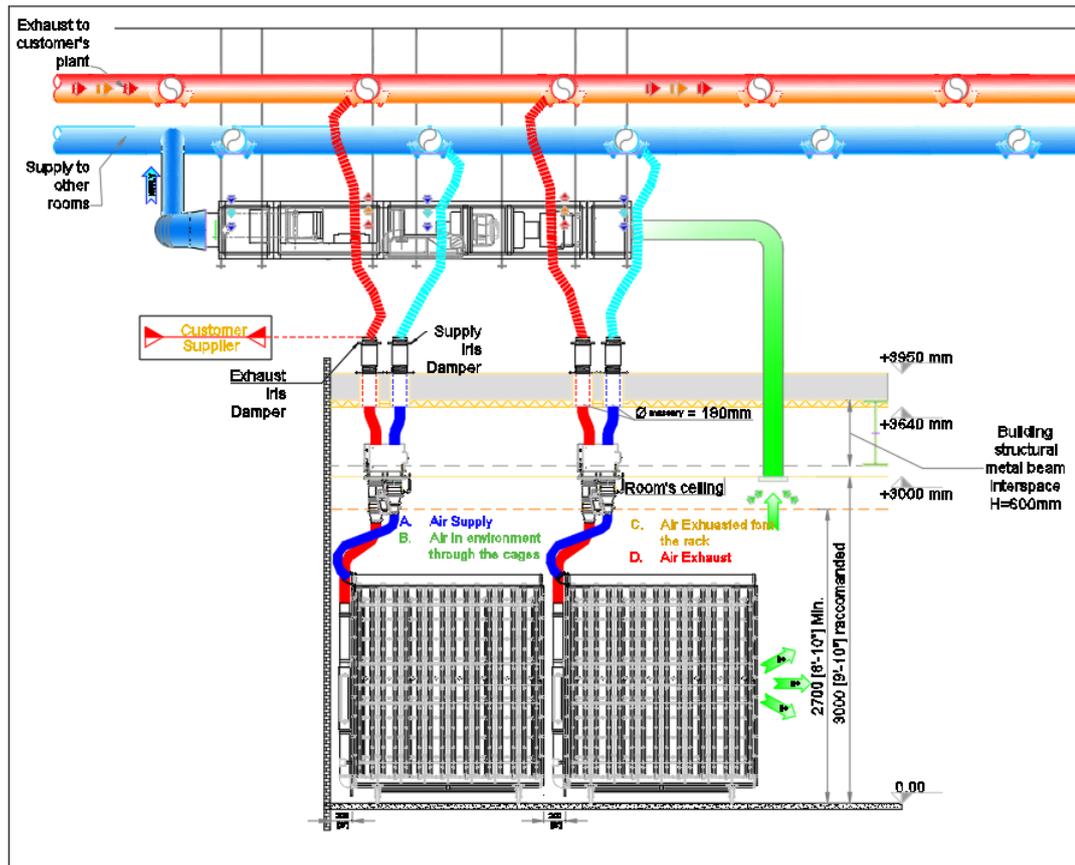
Schema dell'impianto di ventilazione dell'Istituto Emma Mouse Clinic, Monterotondo.¹¹
